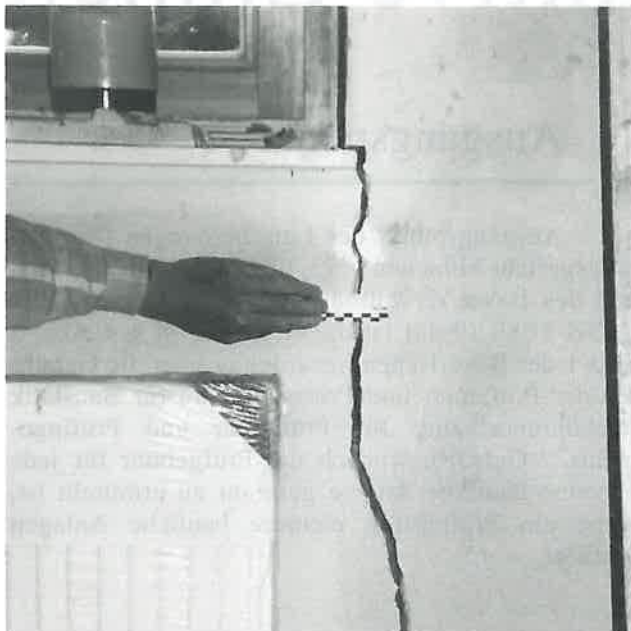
Risse im Außenmauerwerk über Randbalken (Pos. 41, Abb. 2) nach dem Putzen
